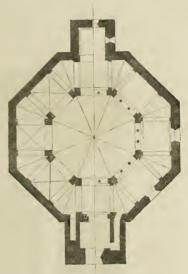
Grundriss der Kirche zu Ottmarsheim.
